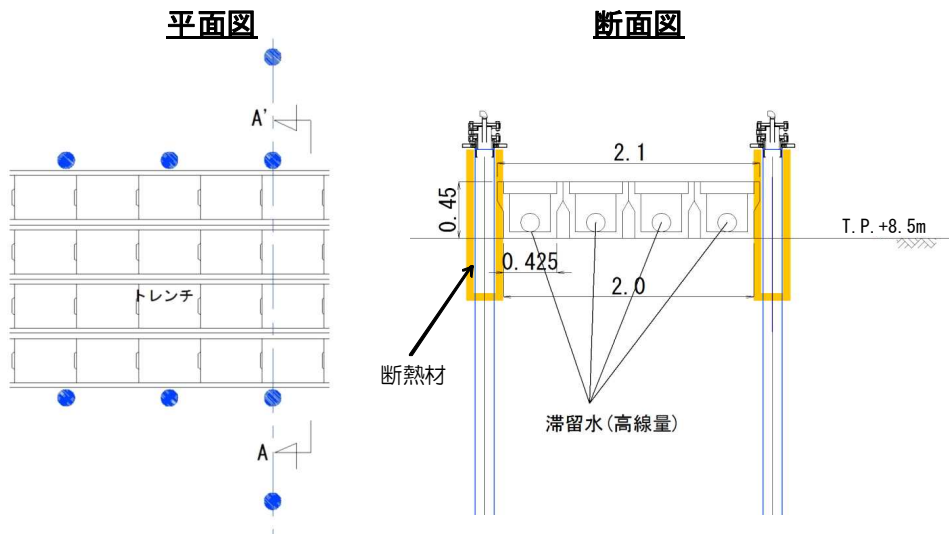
【7-5】 廃棄物系共通配管ダクト② 施工方法（貫通施工）
